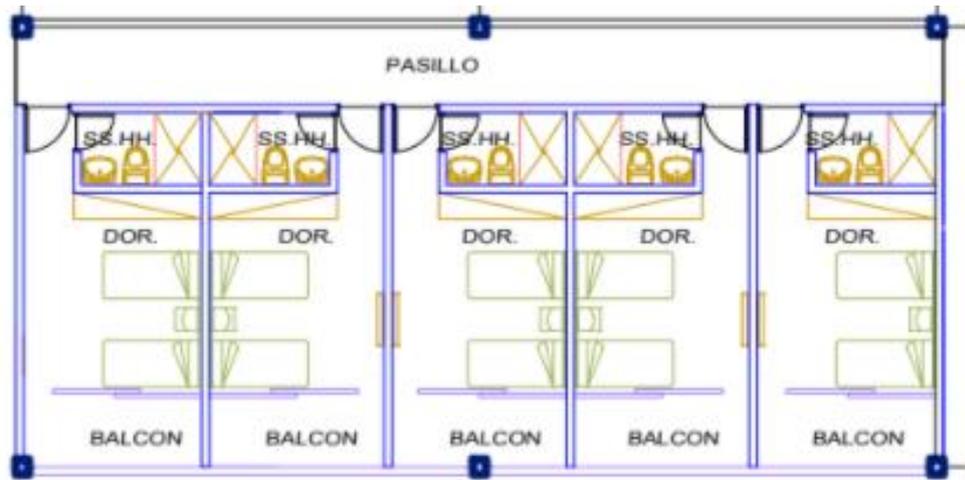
Planta arquitectónica del bloque de dormitorios de la hostería
